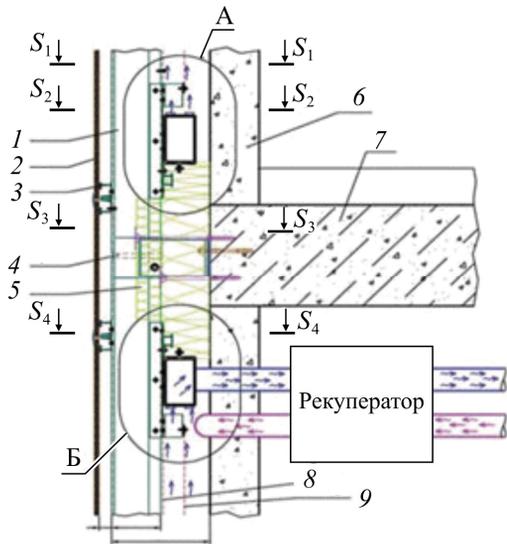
Навесная фасадная система с активным энергосбережением (вертикальный разрез по плите перекрытия) [7]: 1 – вертикальная направляющая; 2 – декоративная облицовка; 3 – ригель крепления облицовки; 4 – кронштейн; 5 – утеплитель; 6 – кладка; 7 – плита перекрытия; 8 – наружный теплоотражающий экран; 9 – внутренний теплоотражающий экран
